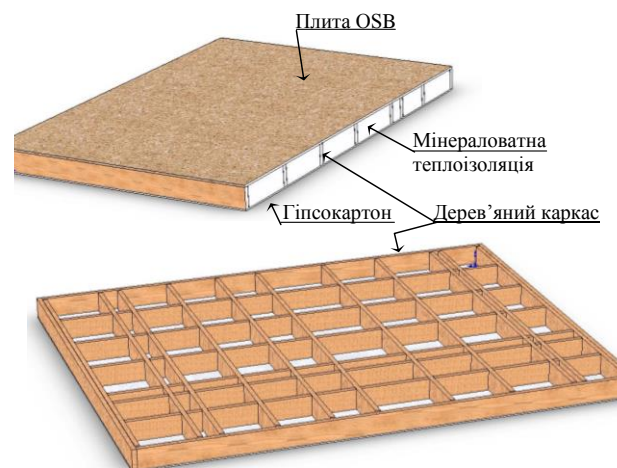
Конструктивна схема дерев'яної плити / Construction scheme of wooden a plate
